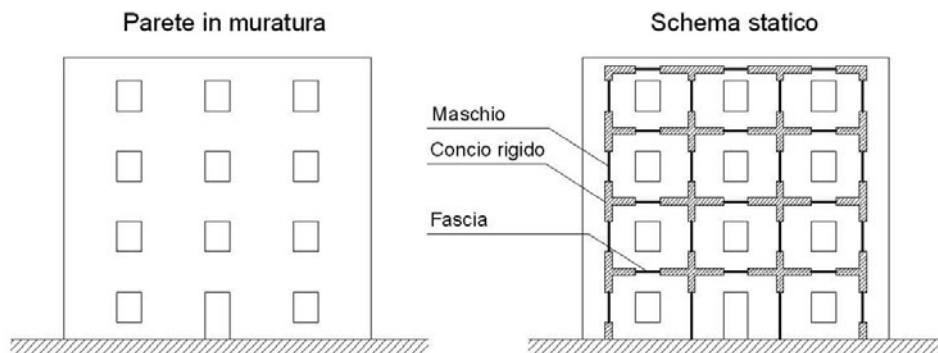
Schematizzazione a telaio equivalente di una parete in muratura
